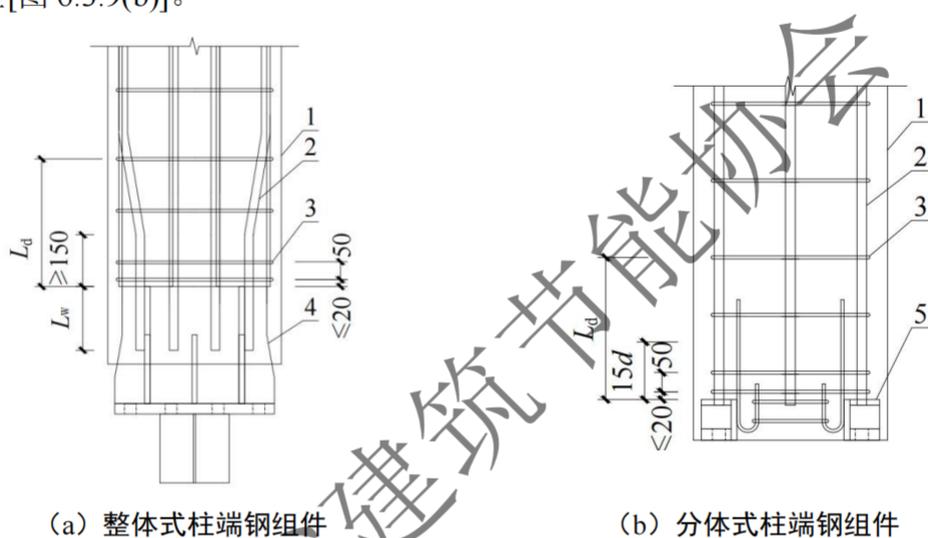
预制柱的纵向受力钢筋和箍筋配置示意
